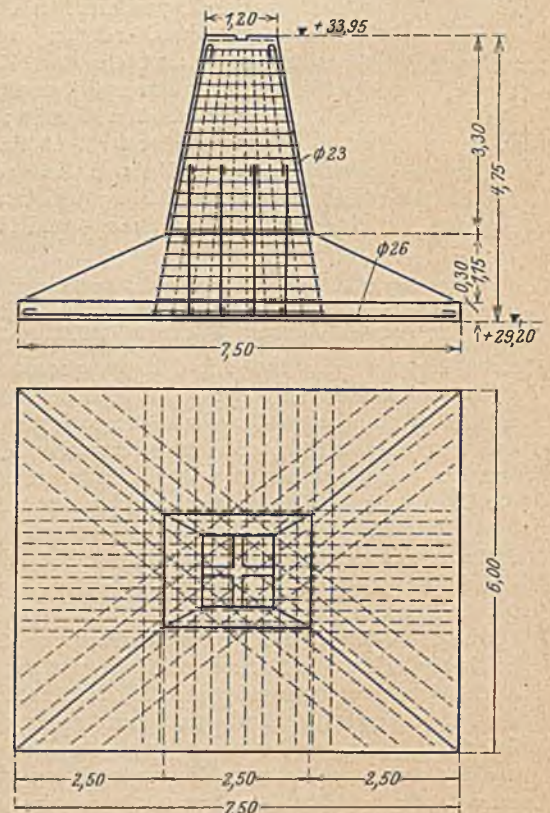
Viaduktstrecke. Eisenbetonfundament zwischen Siemensdamm und Holtzdamm.
